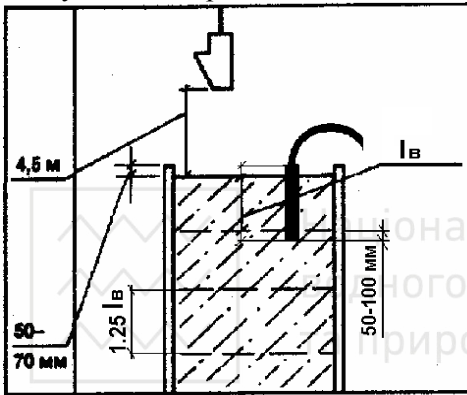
Допуски при бетонуванні фундаментів
